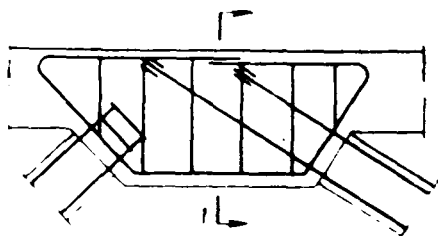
Армирование промежуточного узла фермы с закладными раскосами
